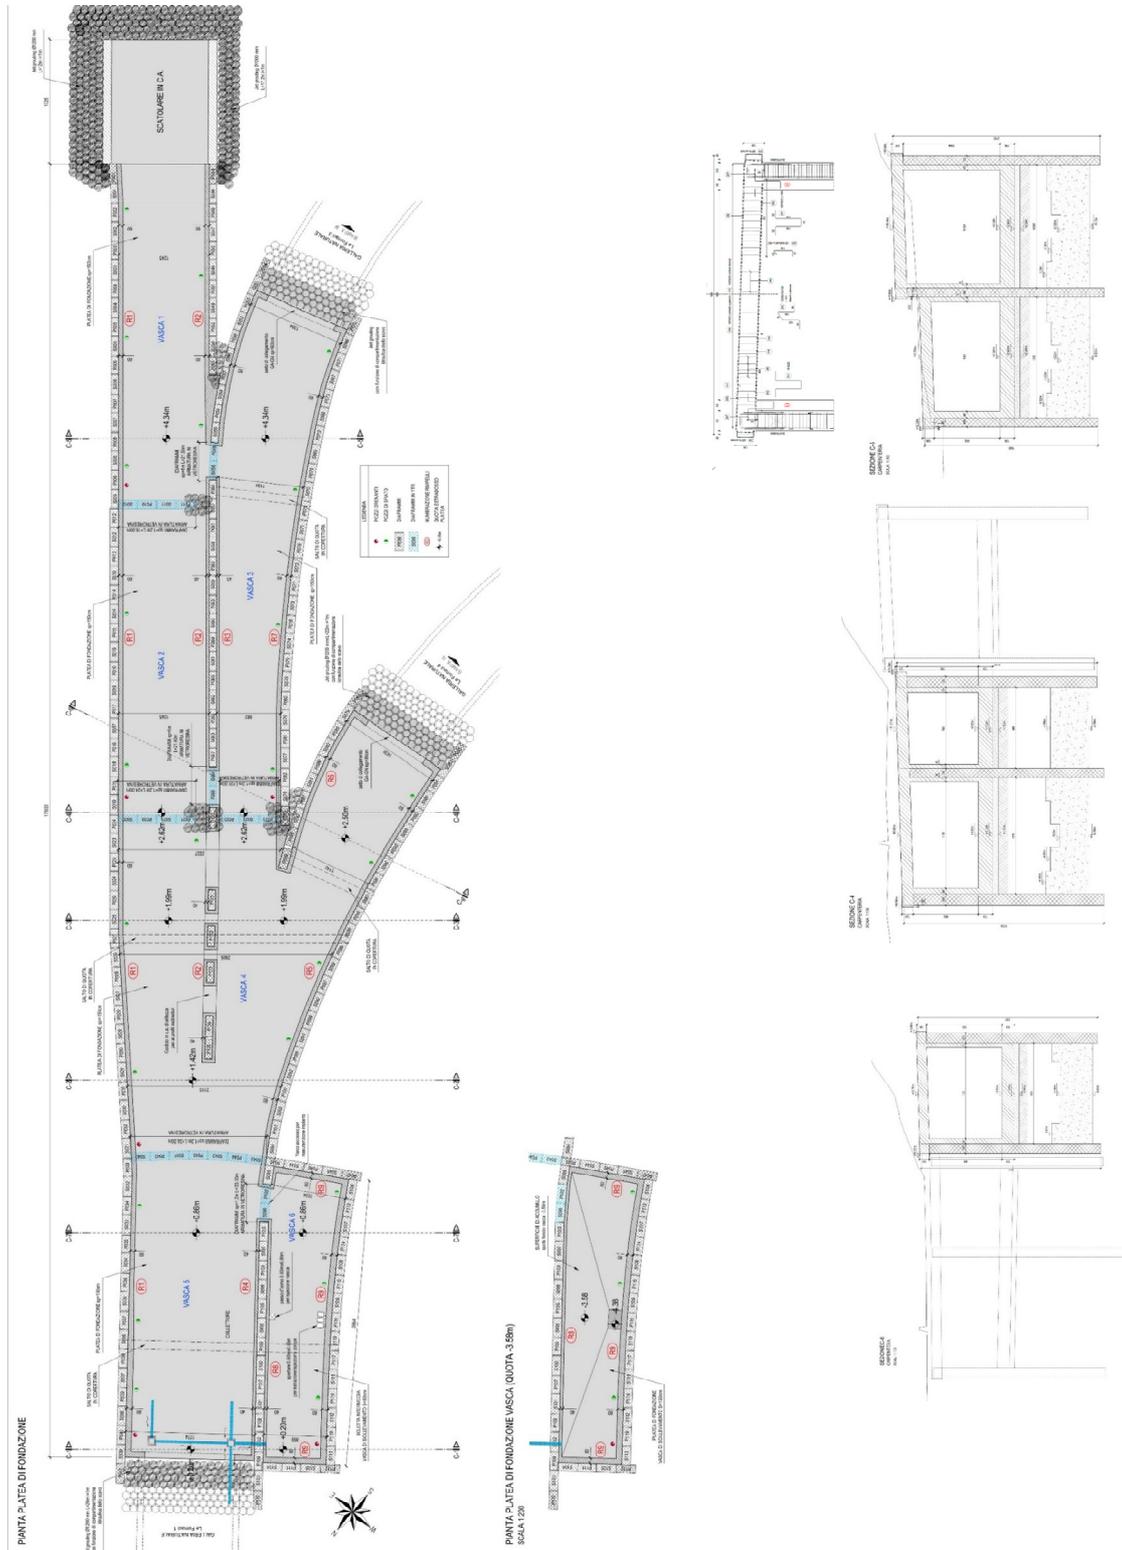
Galleria artificiale Fornaci II – Planimetria e sezioni
